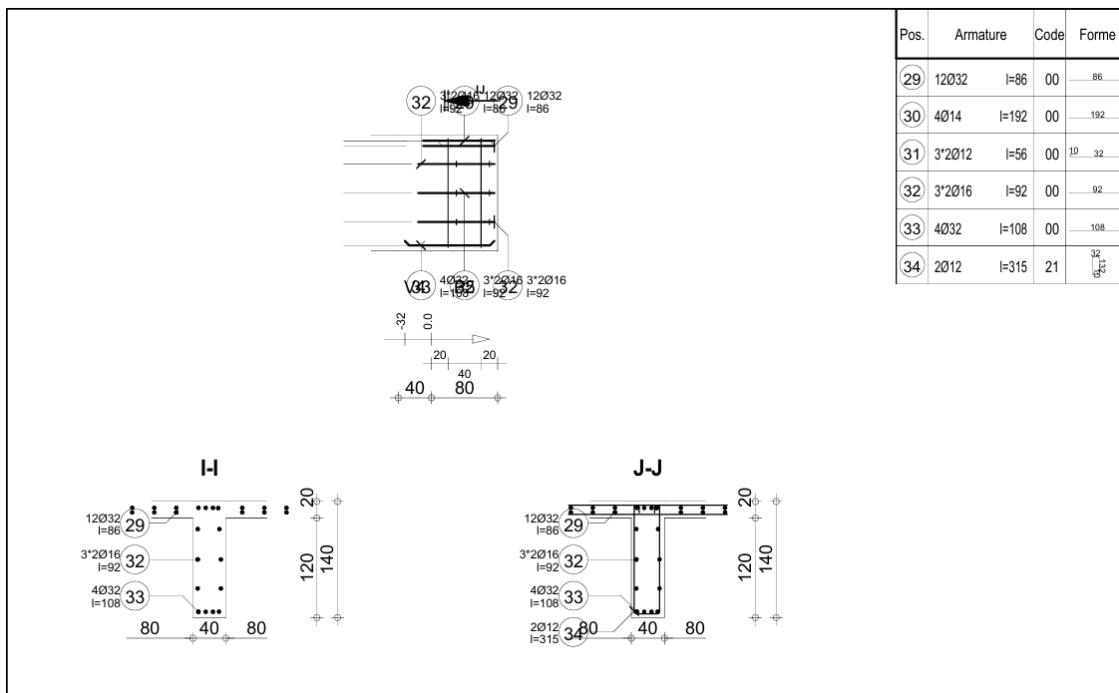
Plans des ferrailages de l'entretoise intermédiaire par la MEF (coupes I-I et J-J)
